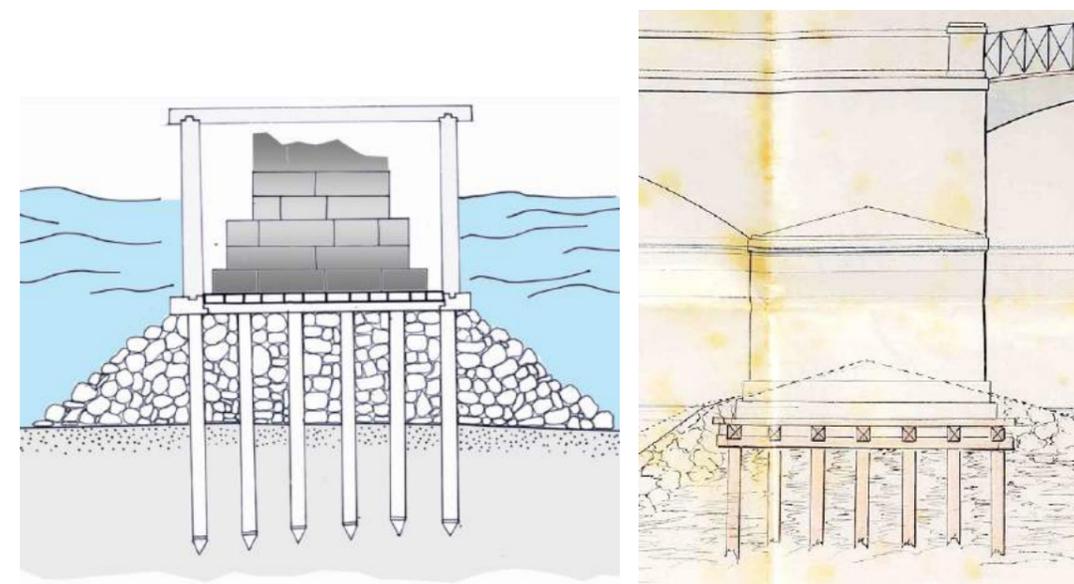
Izquierda, detalle típico de la disposición de piedra escollera bajo el emparrillado y entre los pilotes de madera tomada del documento "Cimentaciones de fábrica en puentes", editado por la ATC en 2008. Derecha, alzado de aguas abajo de la pila 3, tomada de los planos del proyecto de reparación de 1892-1893, donde se puede observar la cimentación original de la pila.
